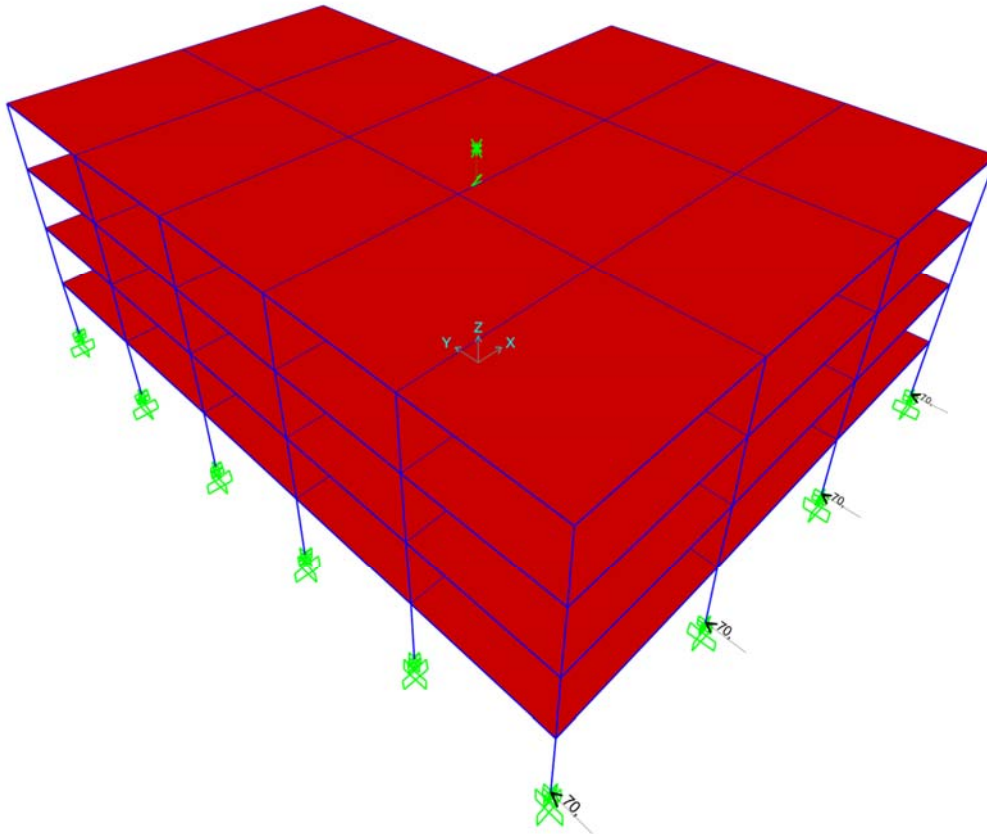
Modelo 3D estructura aislada, ensayo pull-back.
